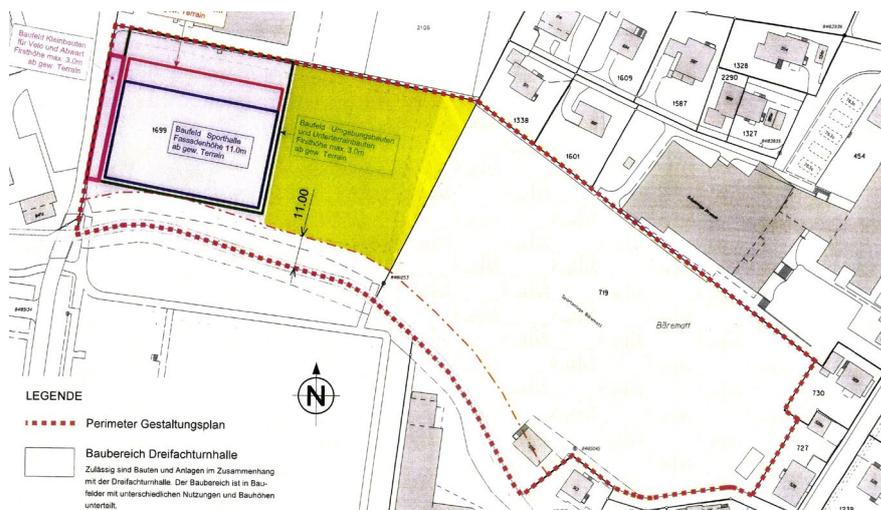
Gestaltungsplan Bärenmatt mit Baulinie zur Sicherung des Gewässerräume (2014)
